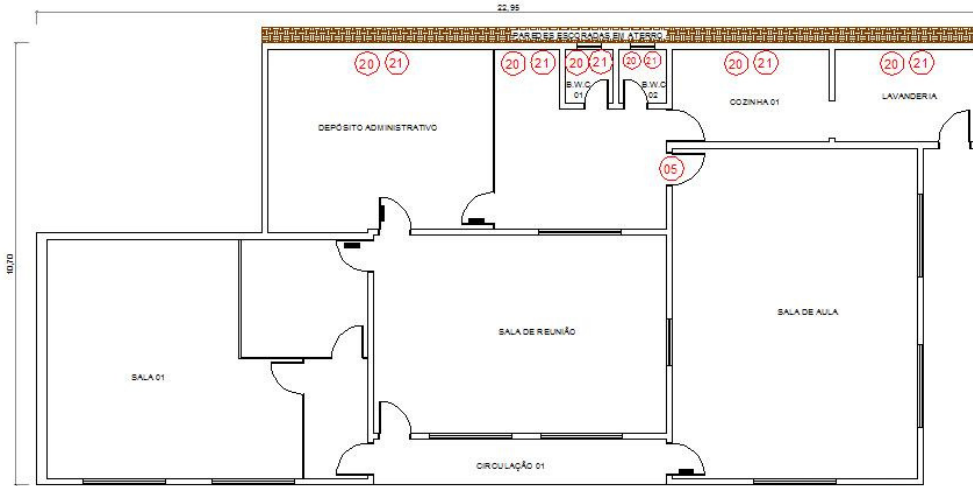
Planta Baixa Térreo Favinho de Mel – 1 de Maio
